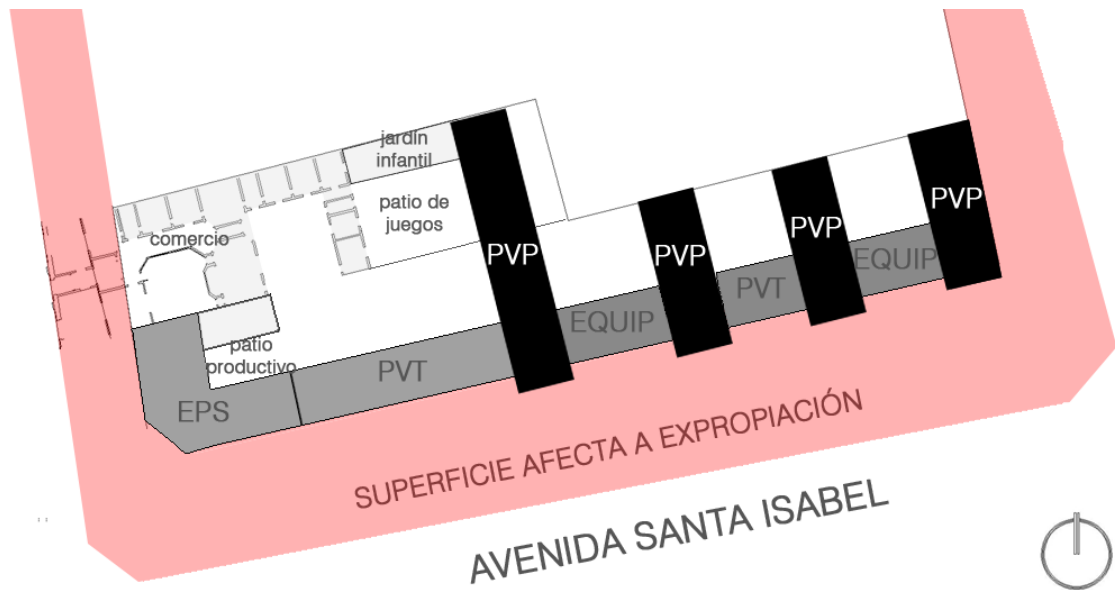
Plano esquemático de partido aproximación a partido general. Fuente: Elaboración propia
